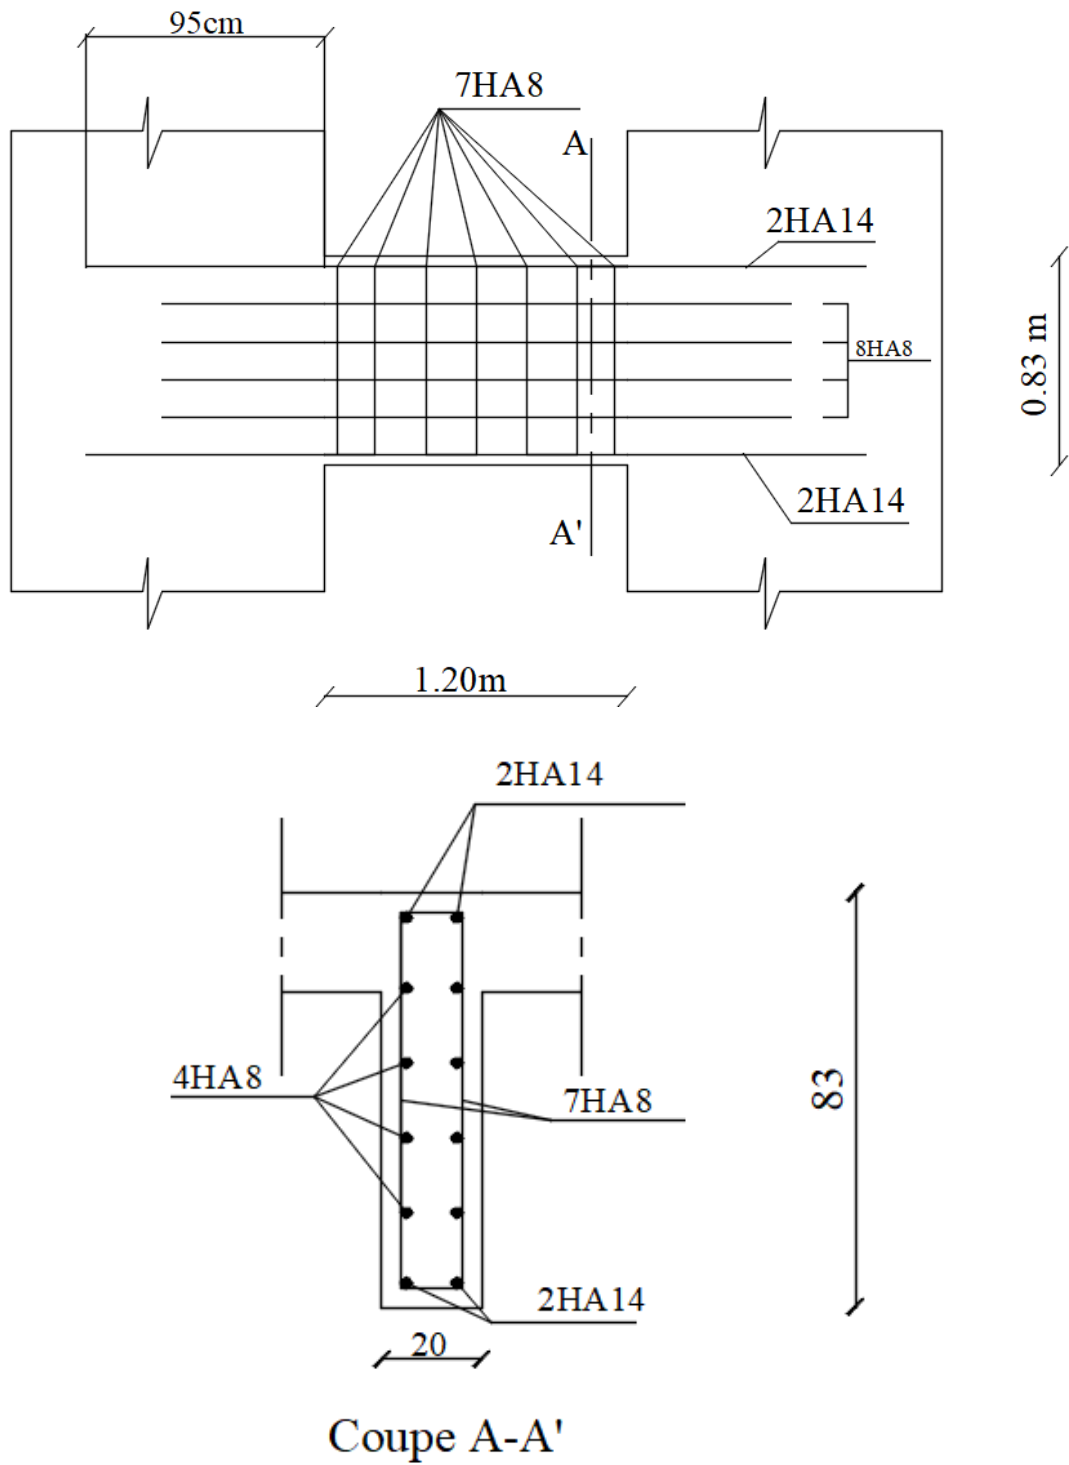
Schéma de ferrailage du linteau VL1 (Zone III).
